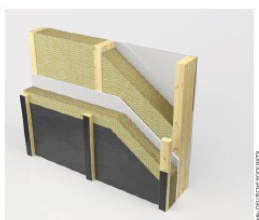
ROCKWOOL Steinwolle in der Fassade: eine von mehr als zehn sicheren Anwendungen für den Holzbau
